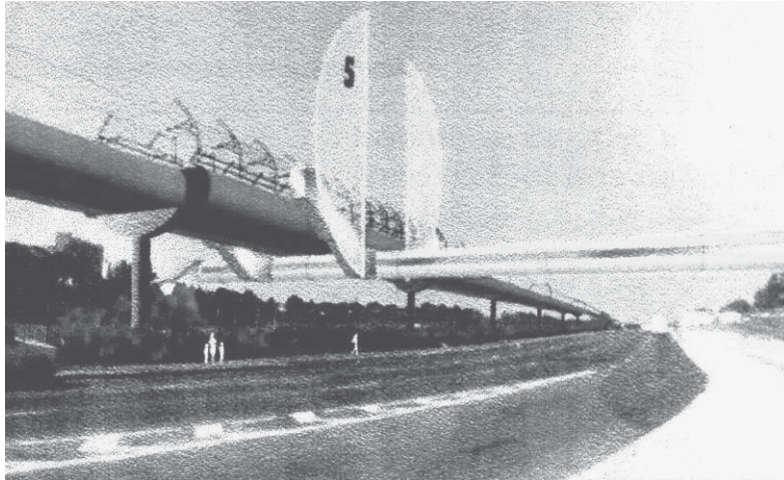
Diseño de la futura estación del “acaba fila” en São Paulo. Se instalará en una vía elevada, en el carril central diferenciado — en parte elevado y en parte a nivel — de una avenida, con puente de acceso.
